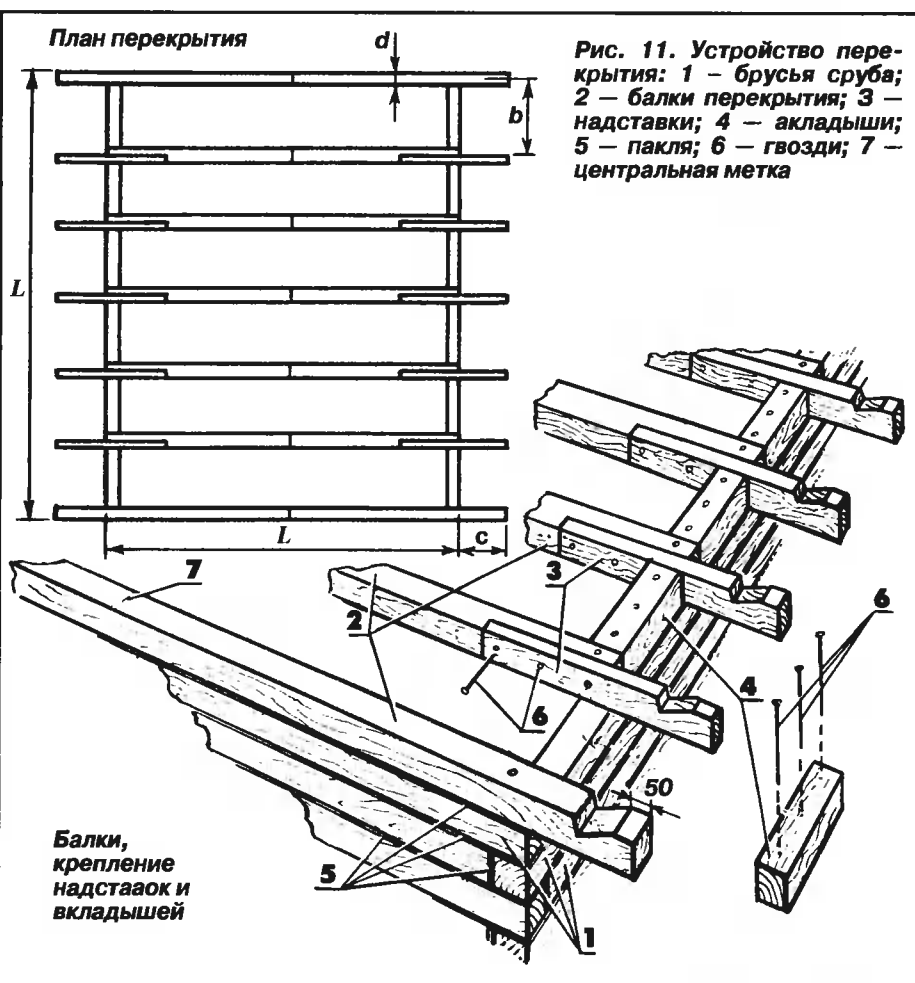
Устройство перекрытия: 1 – брусья сруба; 2 – балки перекрытия; 3 – надставки; 4 – акладыши; 5 – пакля; 6 – гвозди; 7 – центральная метка
